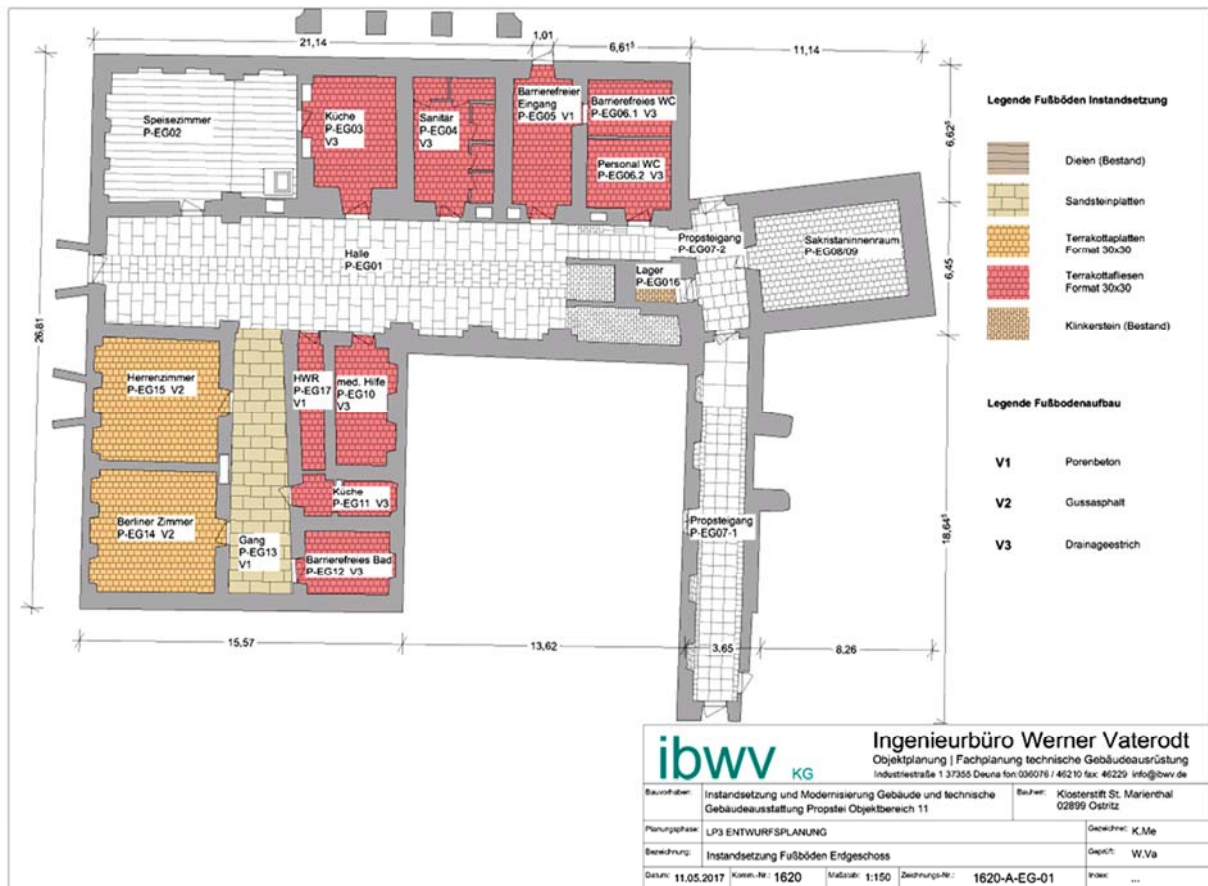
Grundriss der Propstei mit Darstellung des Erdgeschosses, Eintragungen der Fußbodenaufbauten und Oberflächenmaterialien
